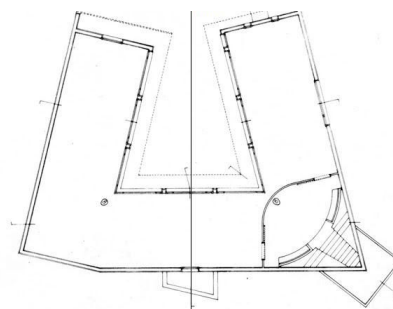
Planta Pavilhão Carlos Ramos. Escola de Arquitetura do Porto. (1986) Sem Escala.
